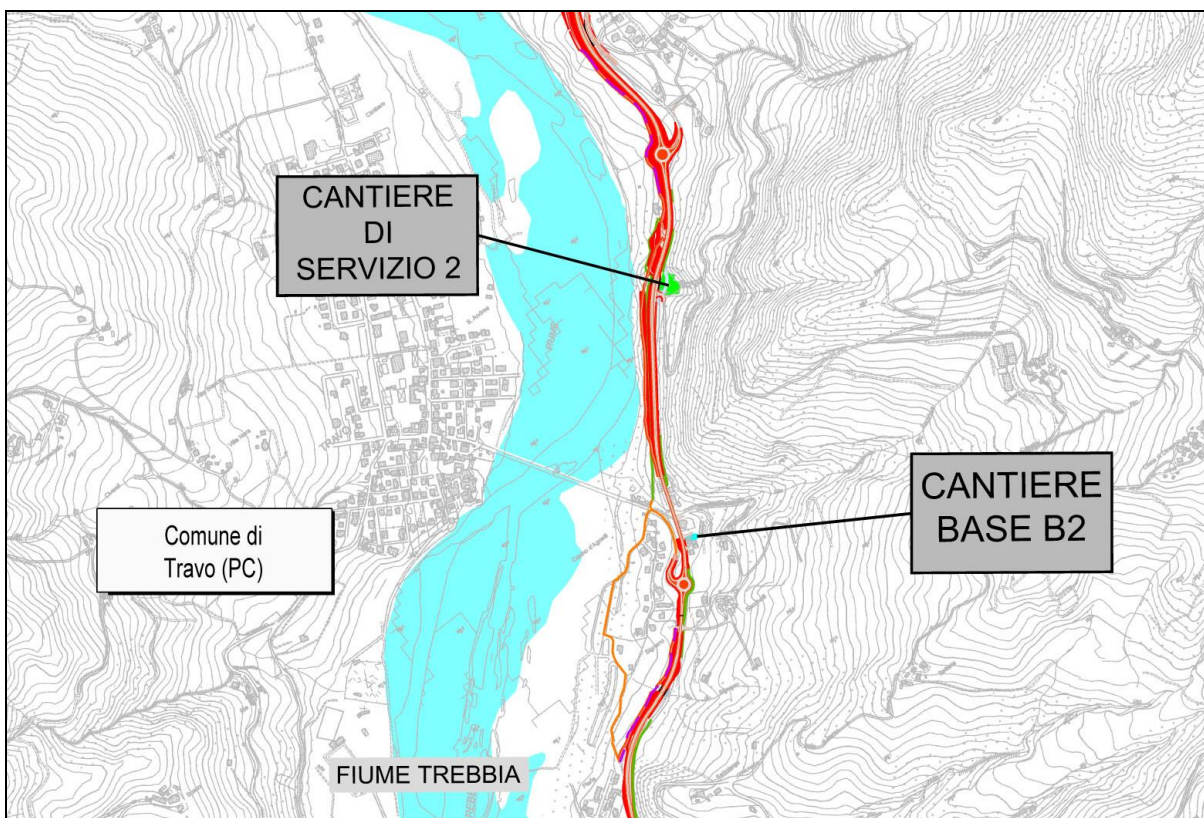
Tracciato in progetto e localizzazione delle aree di cantiere
